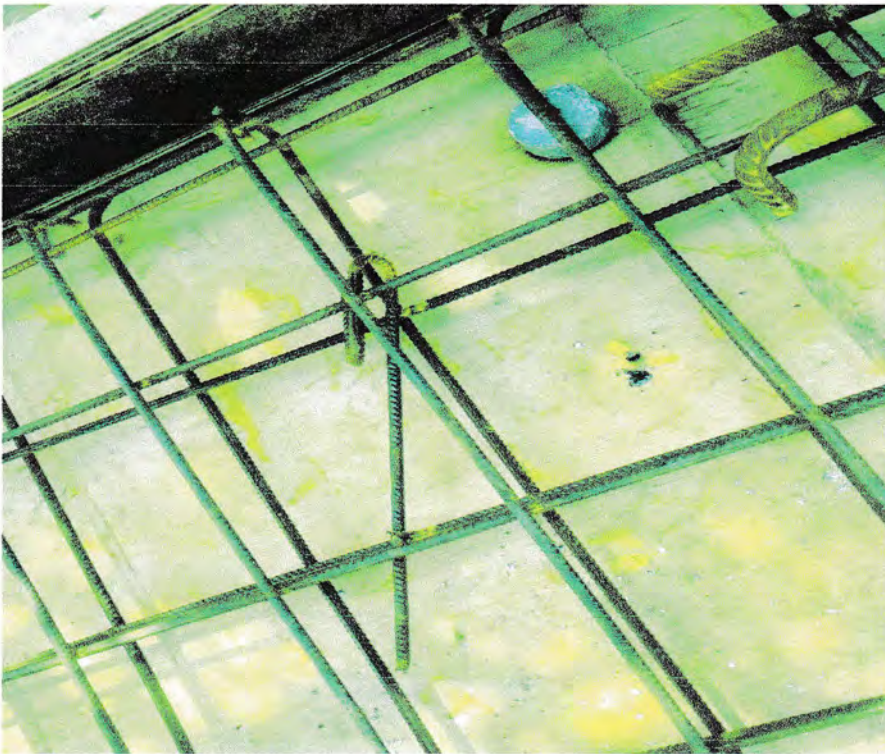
Pemasangan Beton Decking dan Tulangan kaki
